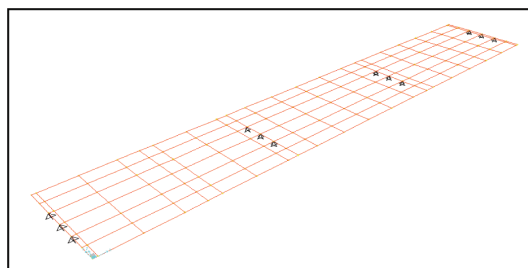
Modellazione 3D dell'impalcato a solettone in c.a.p. del viadotto Tassone. 3D model of the pre-stressed slab deck of the Tassone viaduct.
